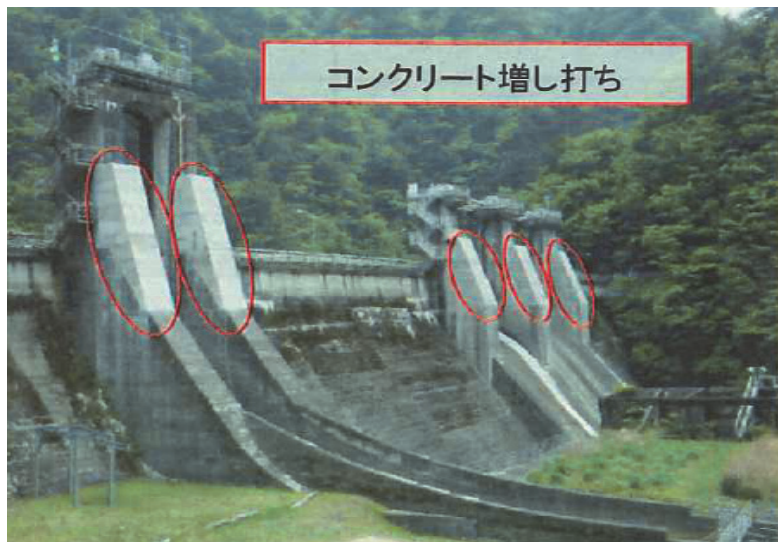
コンクリート増厚事例 (事例シート 1-6)
